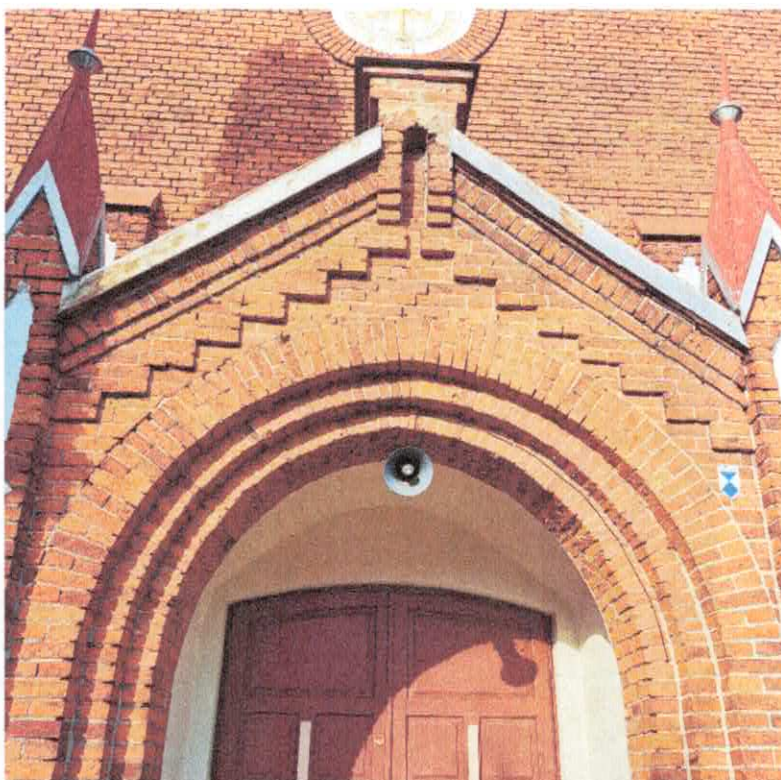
Szczegół przedstawiający stan pęknięcia, zarysowania muru na elewacji wschodniej budynku kościoła.
